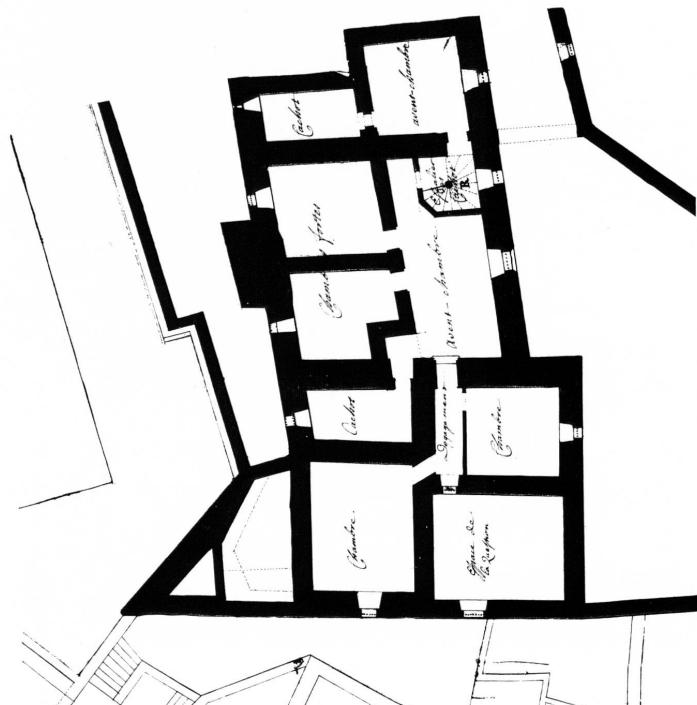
Plan Billon de 1764. Etage sur caves de la partie nord de l'Évêché, au niveau du rez-de-chaussée de la partie sud.
